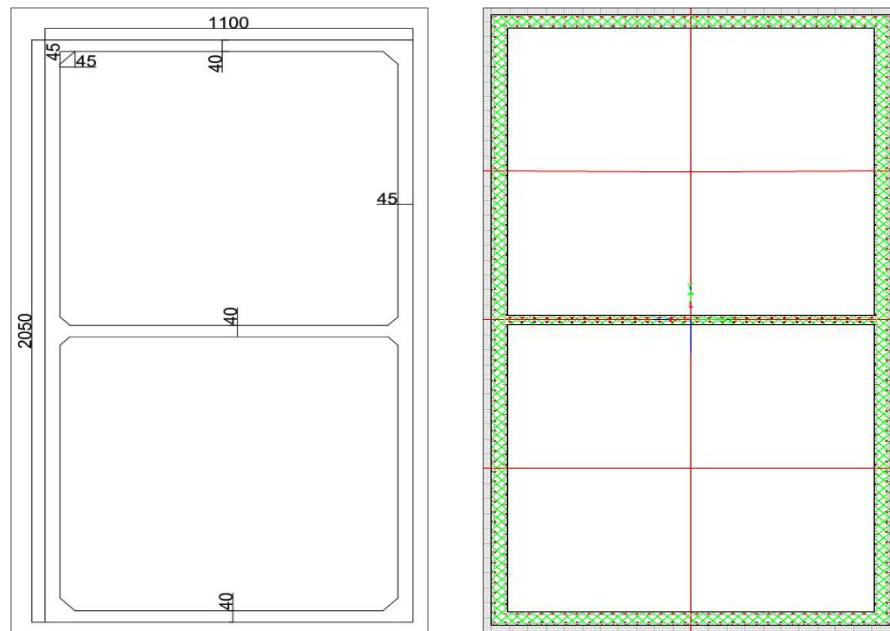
Dimensiones y distribución de refuerzo de la sección inferior de la pila en el tramo atirantado.
